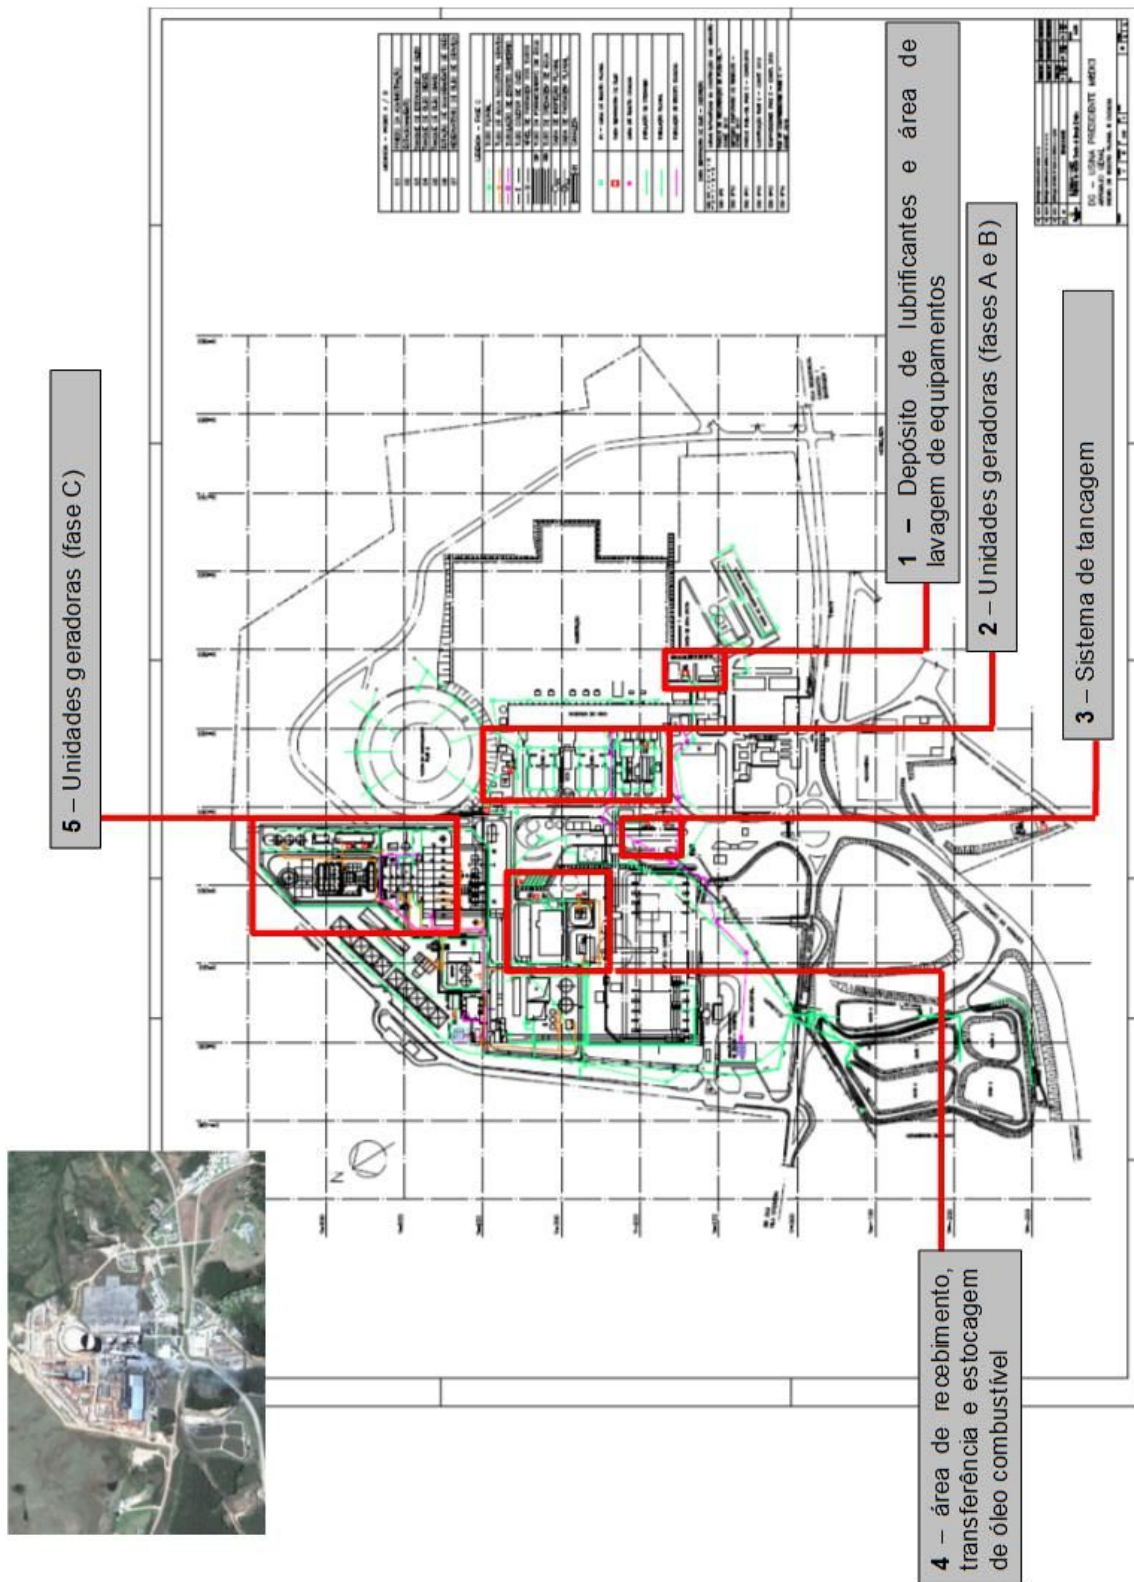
Planta de arranjo geral do complexo e identificação dos pontos vistoriados
